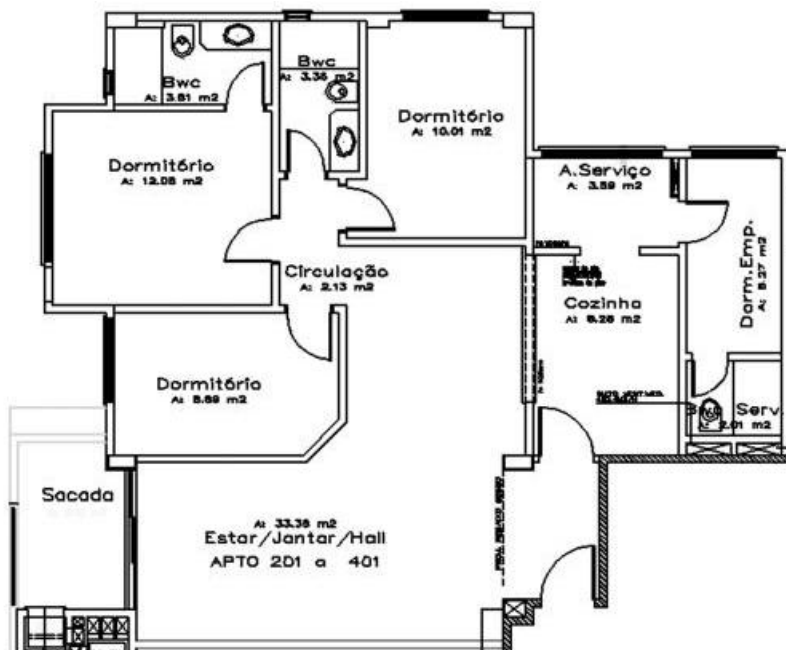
Planta Baixa do apartamento tipo. Fonte: Bolzan (2000)
